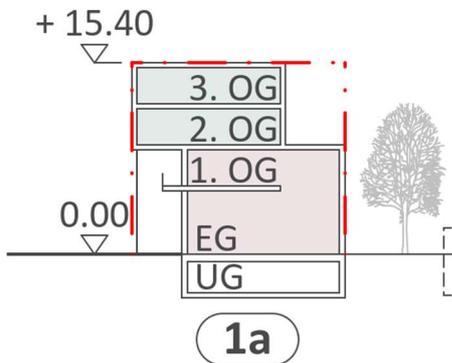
Überhohes Erdgeschoss beim Gebäude 1a
